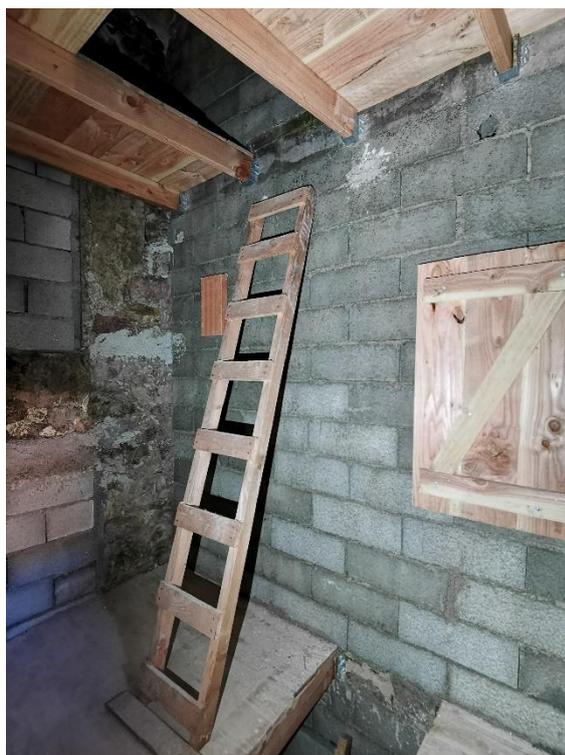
PLANCHER EN BOIS CREE POUR ACCEDER AU
